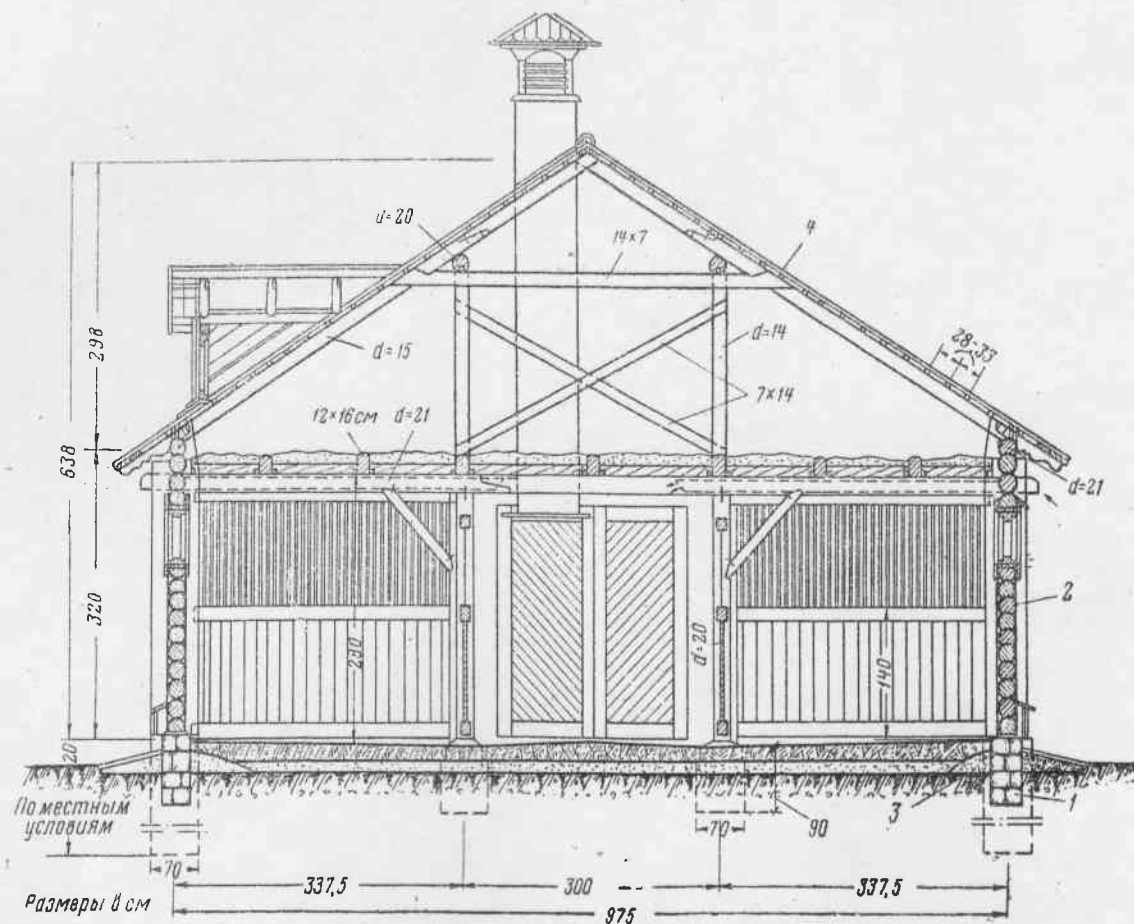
Поперечный разрез конюшни на 20 голов тренировочного молодняка: 1—забирка из буттового камня; 2—стена из бревен; 3—утепление шлаком; 4—кровля черепичная.
